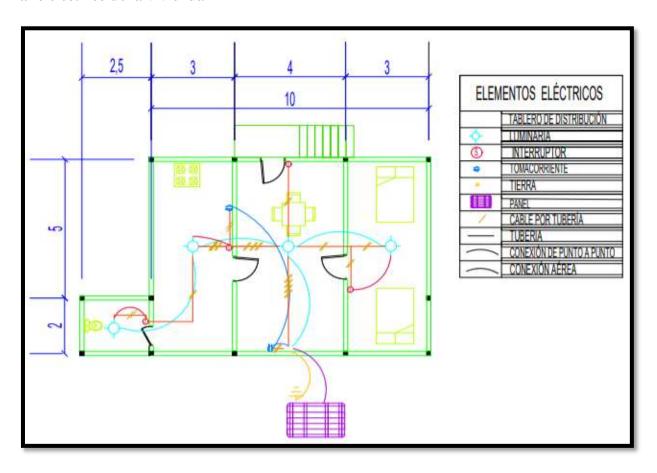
Plano eléctrico de la vivienda beneficiada, fuente: Autores.
